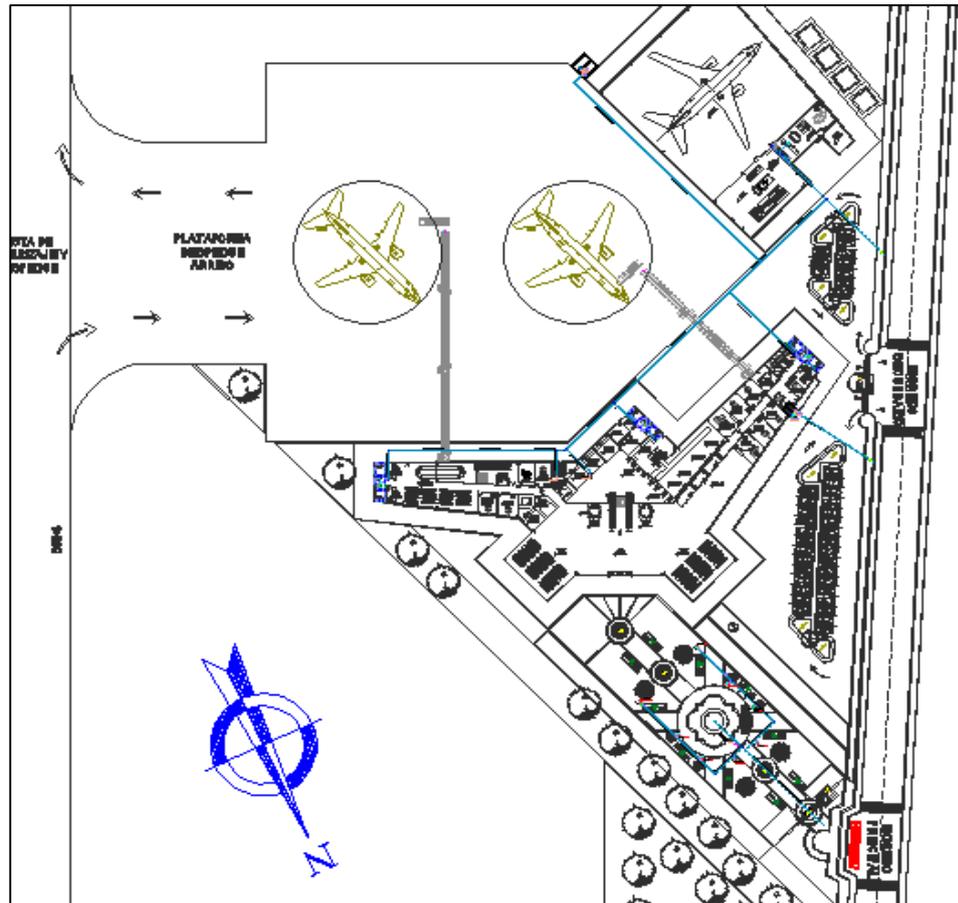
Plano de Instalaciones Sanitarias, Fuente: del plano IS- 01
